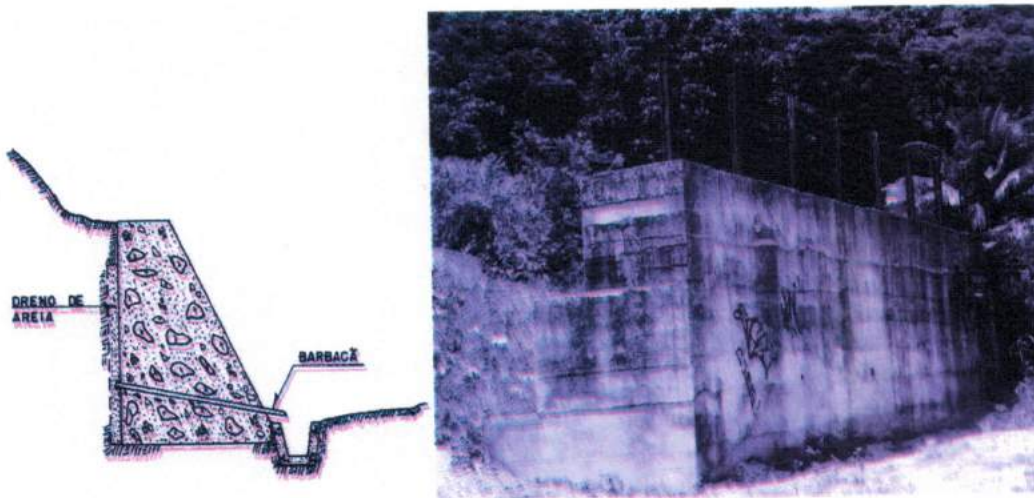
Muros de concreto ciclópico (ou concreto gravidade)
